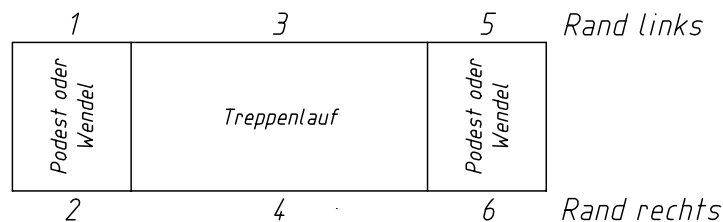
Auflagerzuordnung für quergespannte Treppenkonstruktionen
